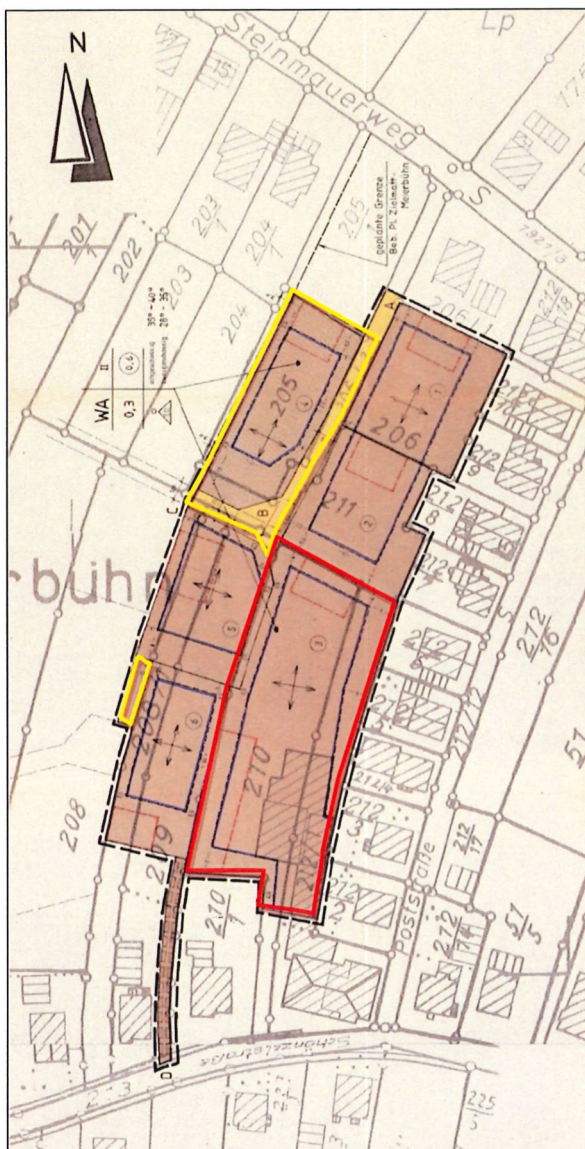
Planzeichnung des Bebauungsplanes „Meierbühn Nord-Ost“, rechtsverbindlich seit dem 01.07.1988, mit schematischer Darstellung der Aufhebungsbereiche vom 28.11.2008 (gelb) und des Änderungsbereichs (rot)
